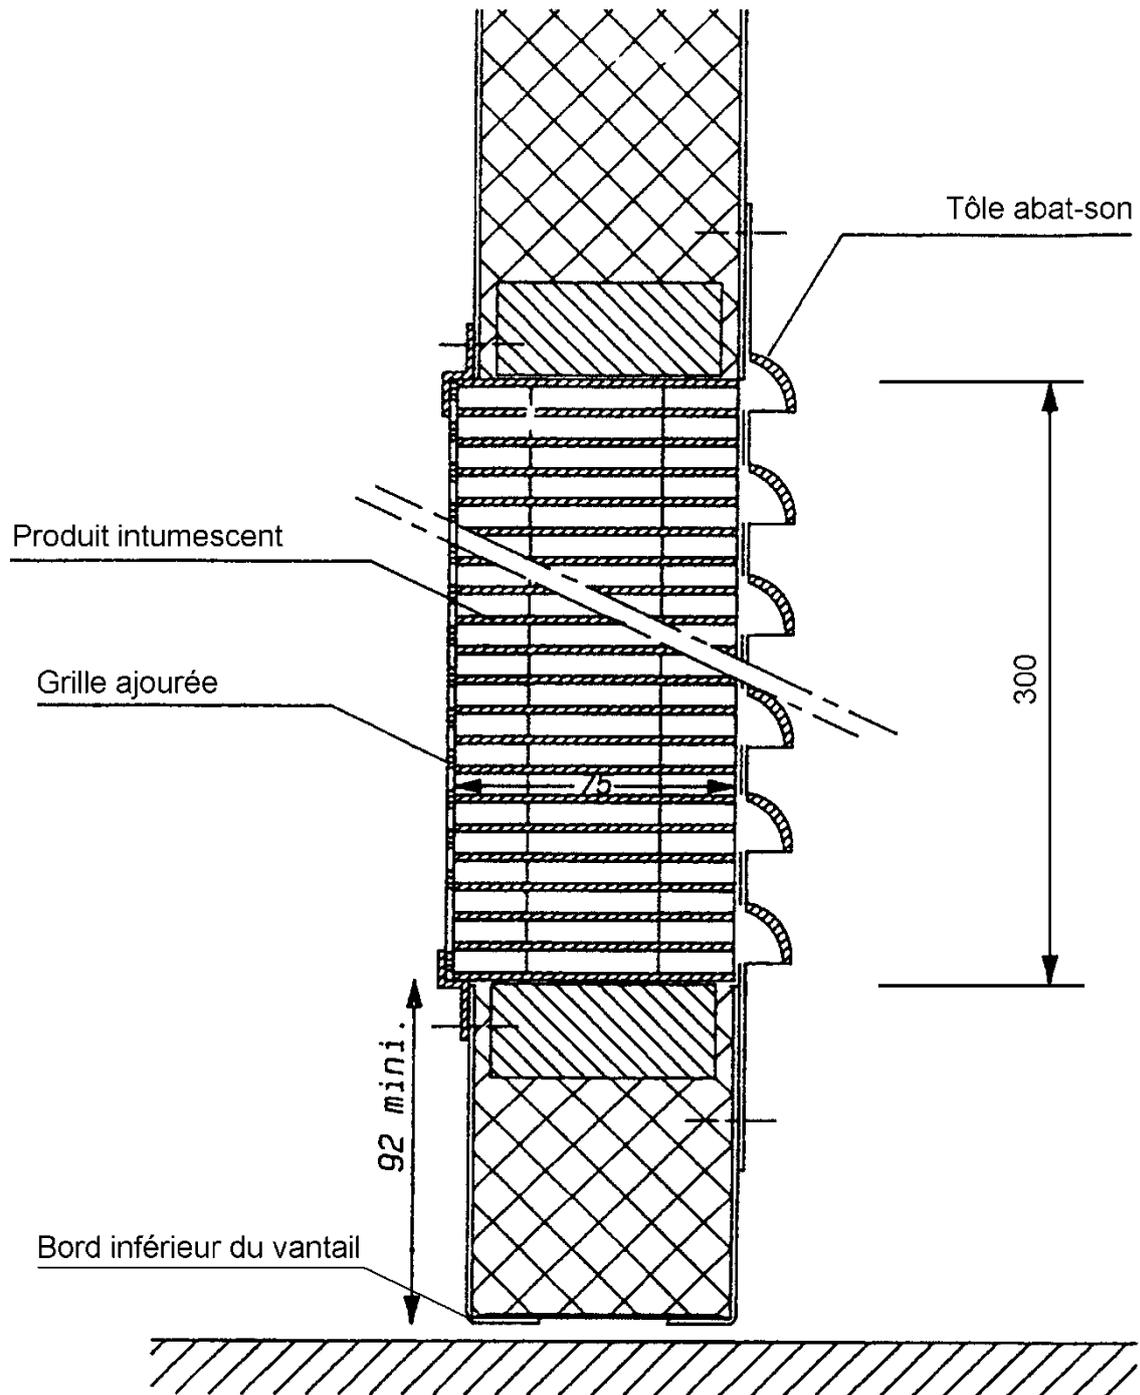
Coupe verticale de la grille de ventilation en bas du vantail
